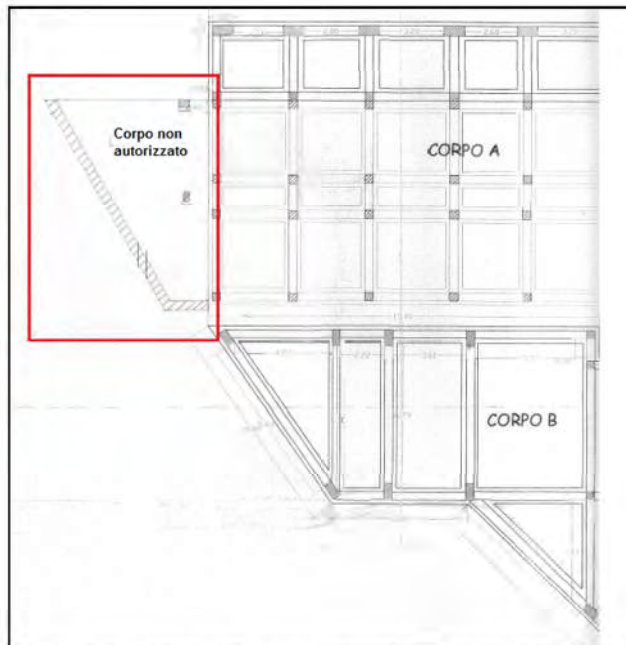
Rappresentazione planimetrica con indicazione in rosso del corpo non autorizzato.
